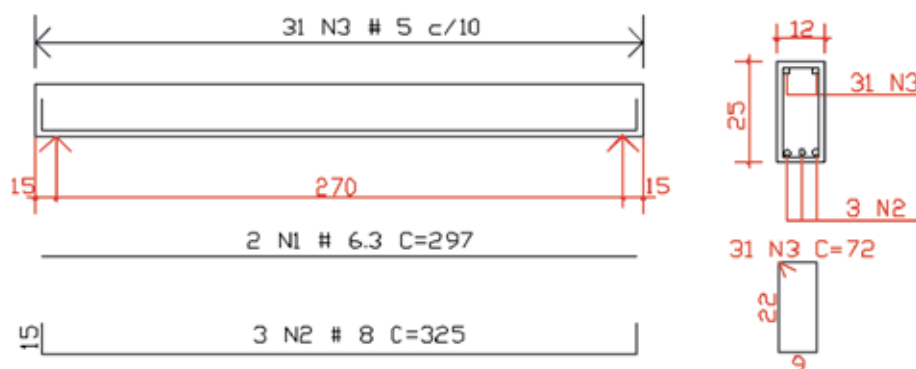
Geometria e armadura das vigas normalmente armadas – VNA
